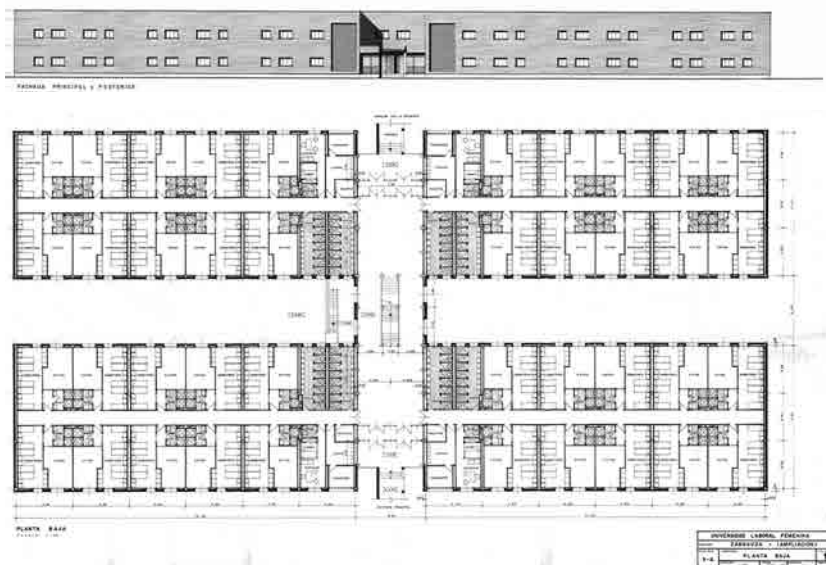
y Fig. 67 Residencias de la Laboral de Zaragoza. Alzado de las fachadas principal y posterior (arriba) y planta baja (abajo) del edificio de residencias de la ampliación.
